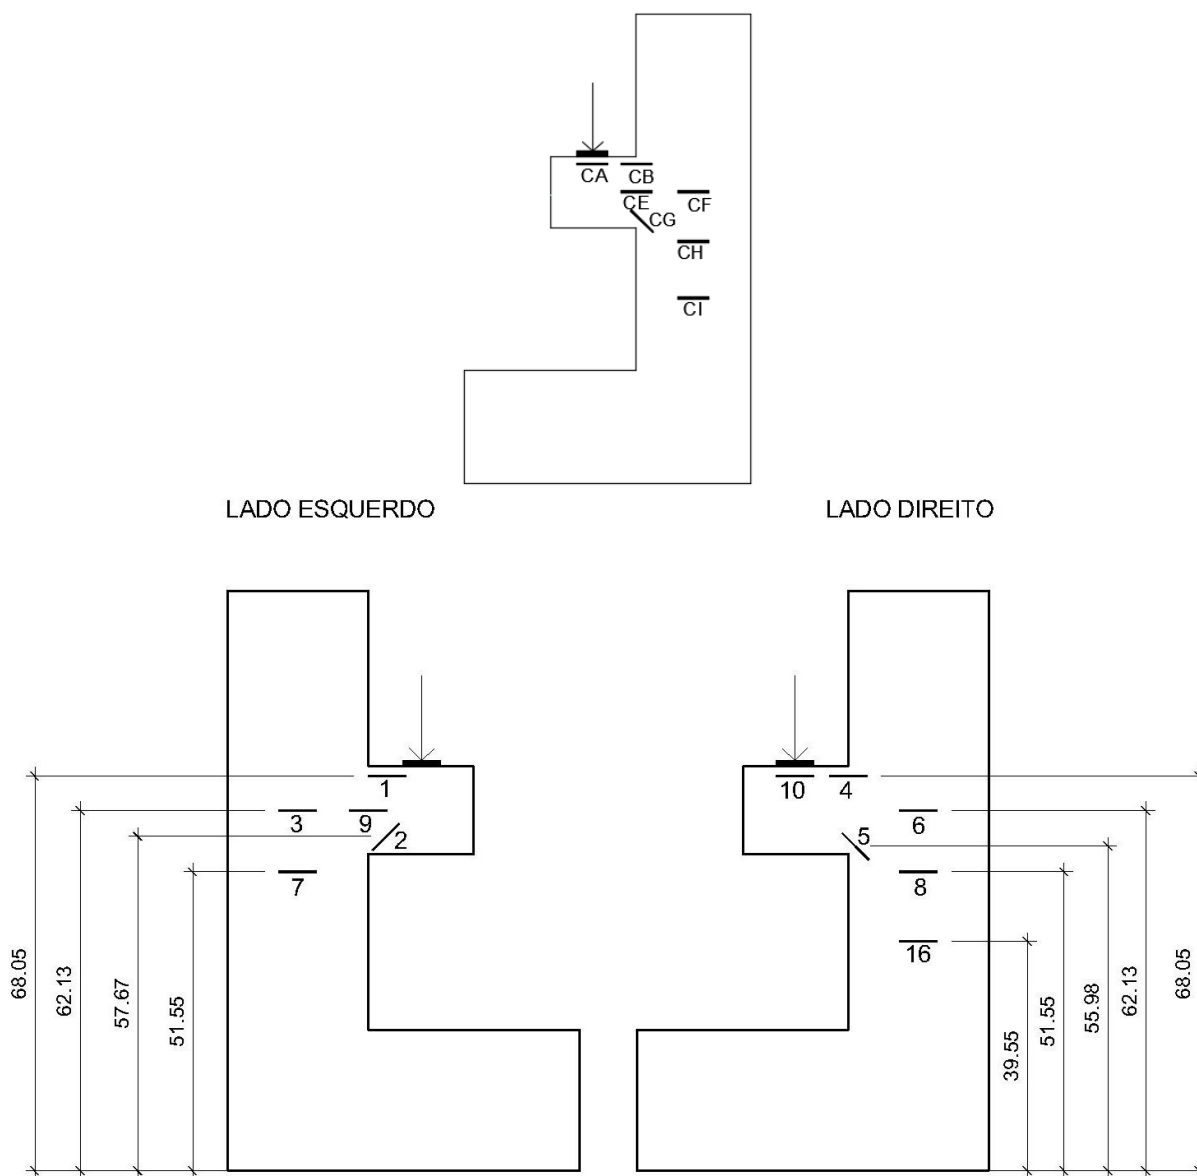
Extensômetros no concreto no modelo P1M2PC
